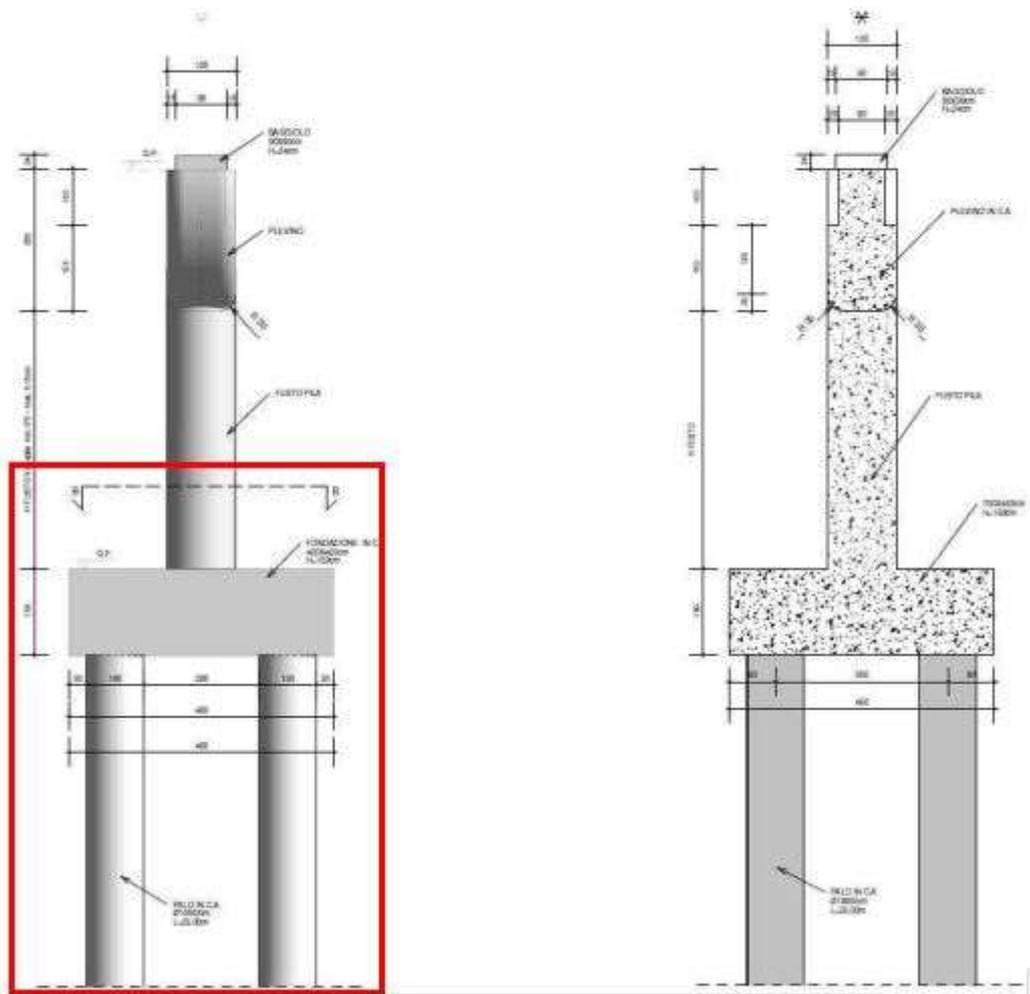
Pile (tipo)- prospetto, sezione e dettaglio fondamenta
